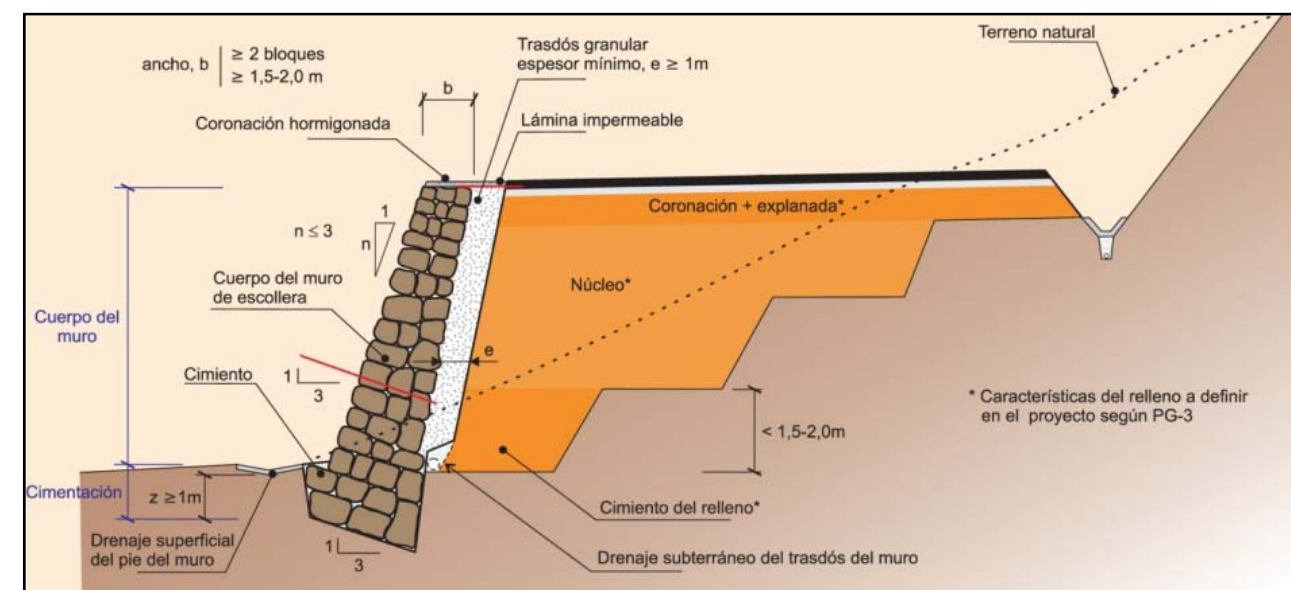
Definición geométrica sección tipo de muro de escollera. Fuente: Guía para el proyecto y la ejecución de muros de escollera en obras de carretera. Ministerio de Fomento.
